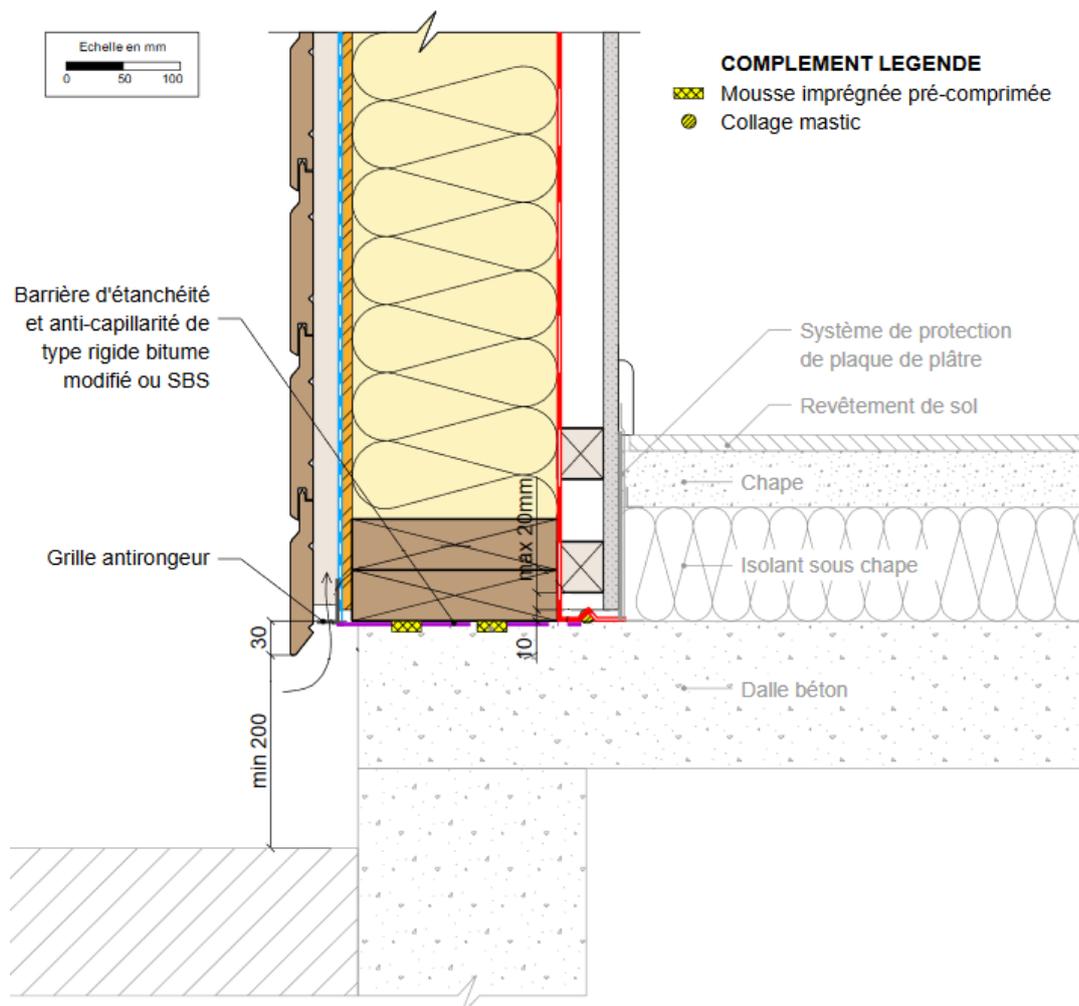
Exemple de raccordements en pied de mur (coupe verticale)
